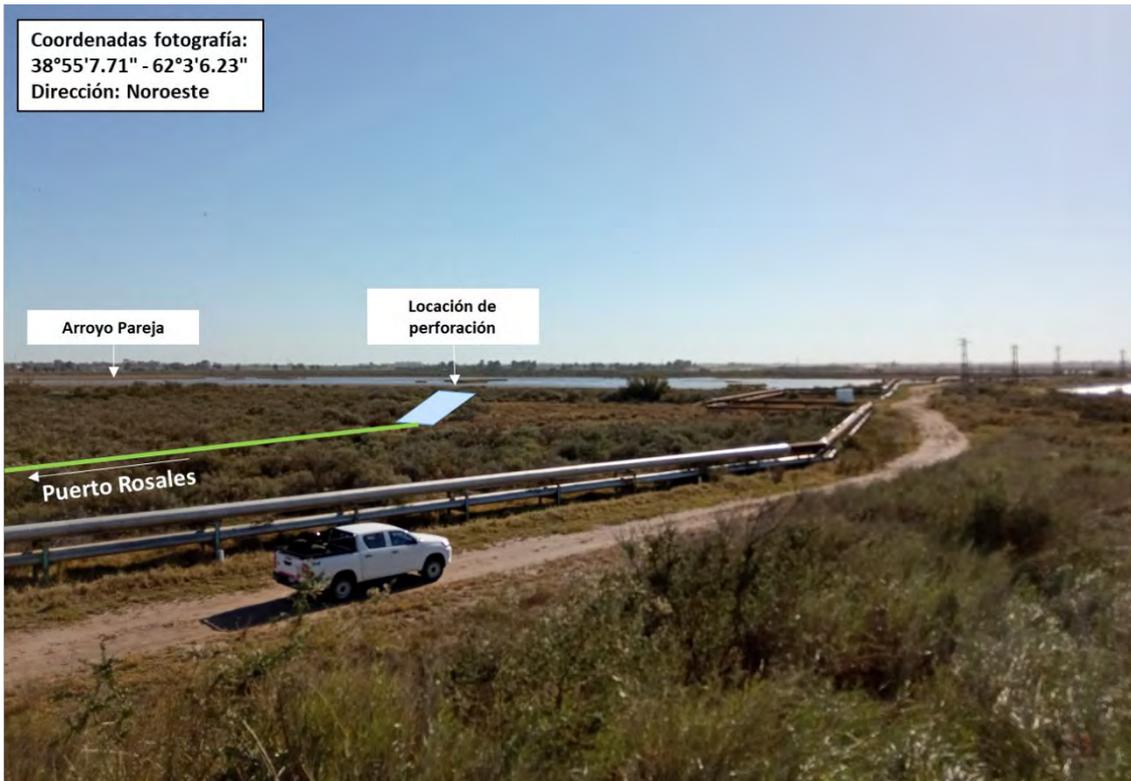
Punto de salida de la perforación horizontal dirigida (PDH) para el cruce del arroyo Pareja
